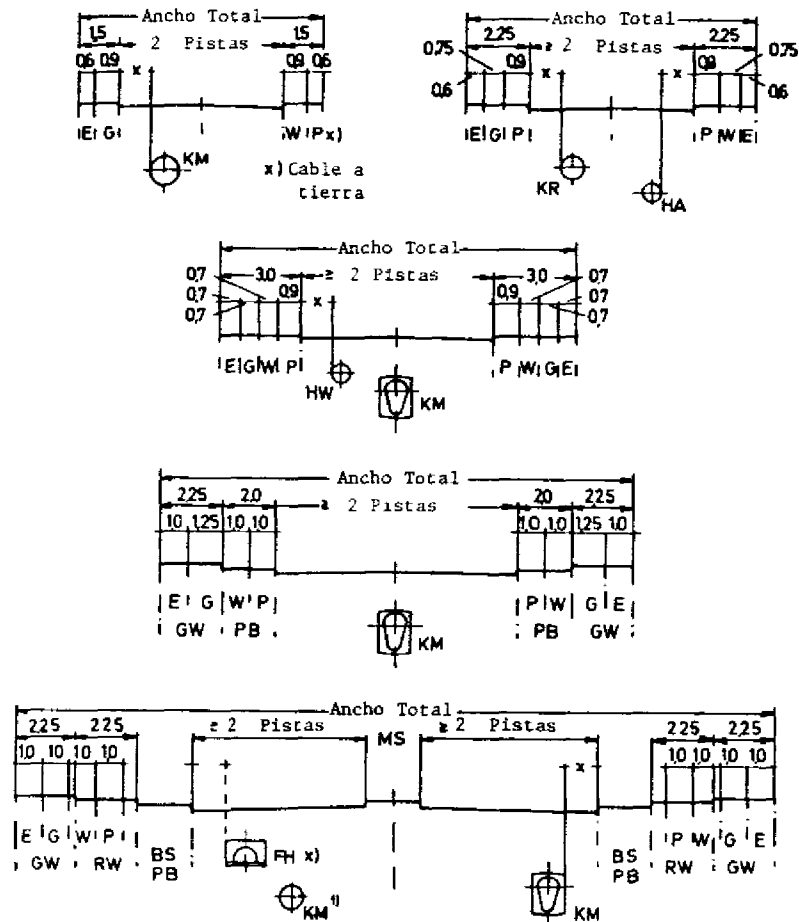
34: Posición de las alcantarillas dentro del perfil de las calles
